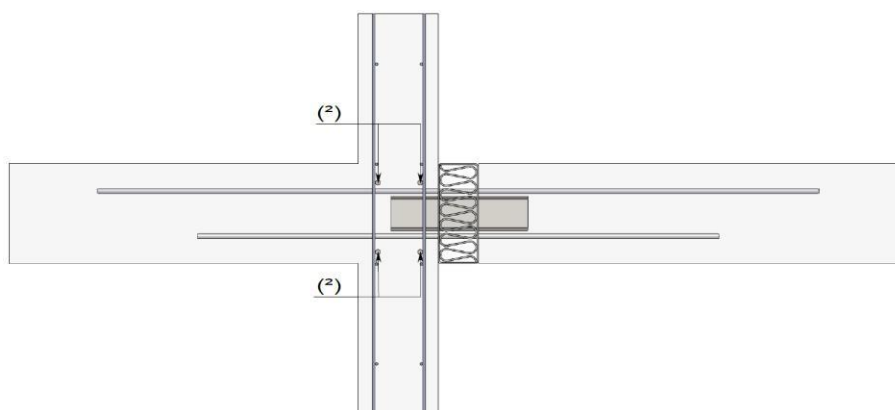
Chainage de mur – liaison dalle – balcon (vue en coupe)
